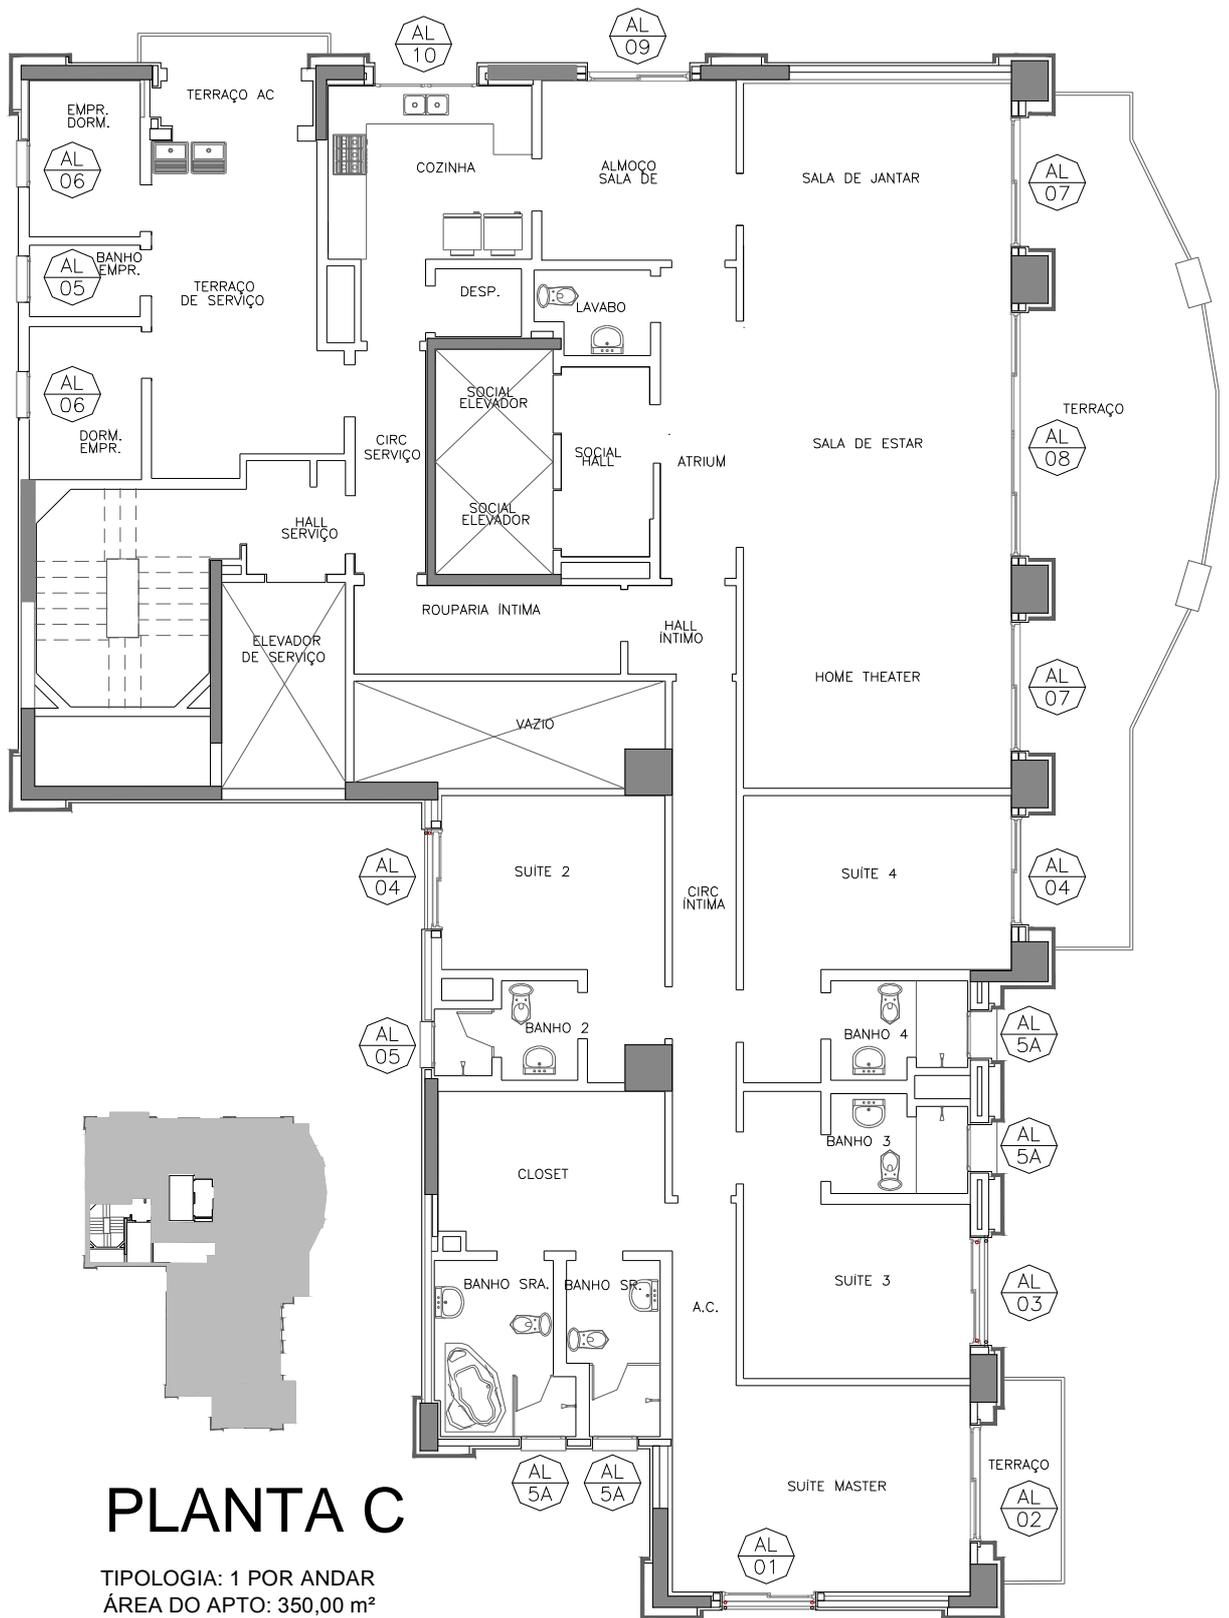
Planta apartamento 1 por andar - indicação dos caixilhos
